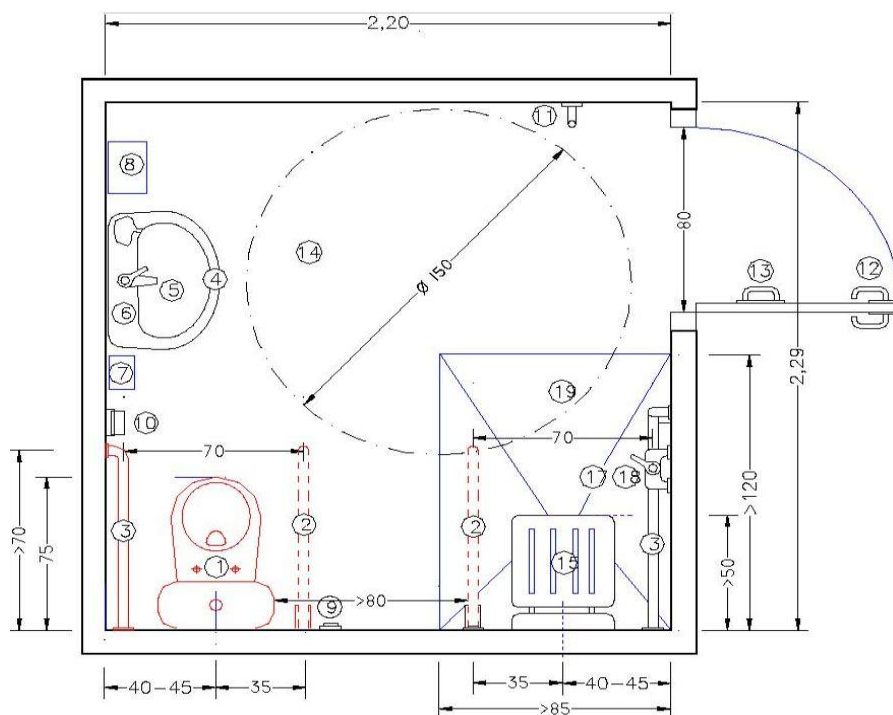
План туалетная, душевая для инвалидов. Установочные и габаритные размеры.
